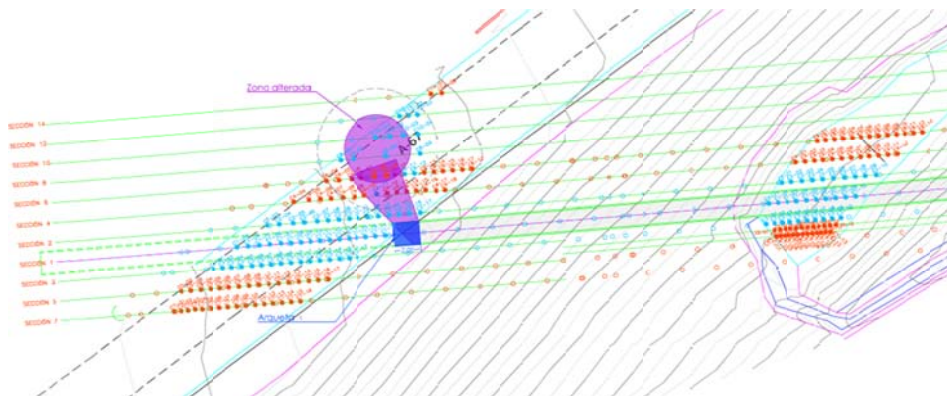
Plano. Vista en planta de las zonas de actuación y zona alterada en el ramal de salida de la A-67.
